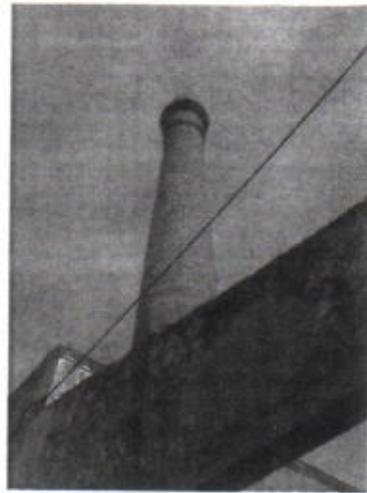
Fissuração longitudinal acentuada na chaminé industrial
